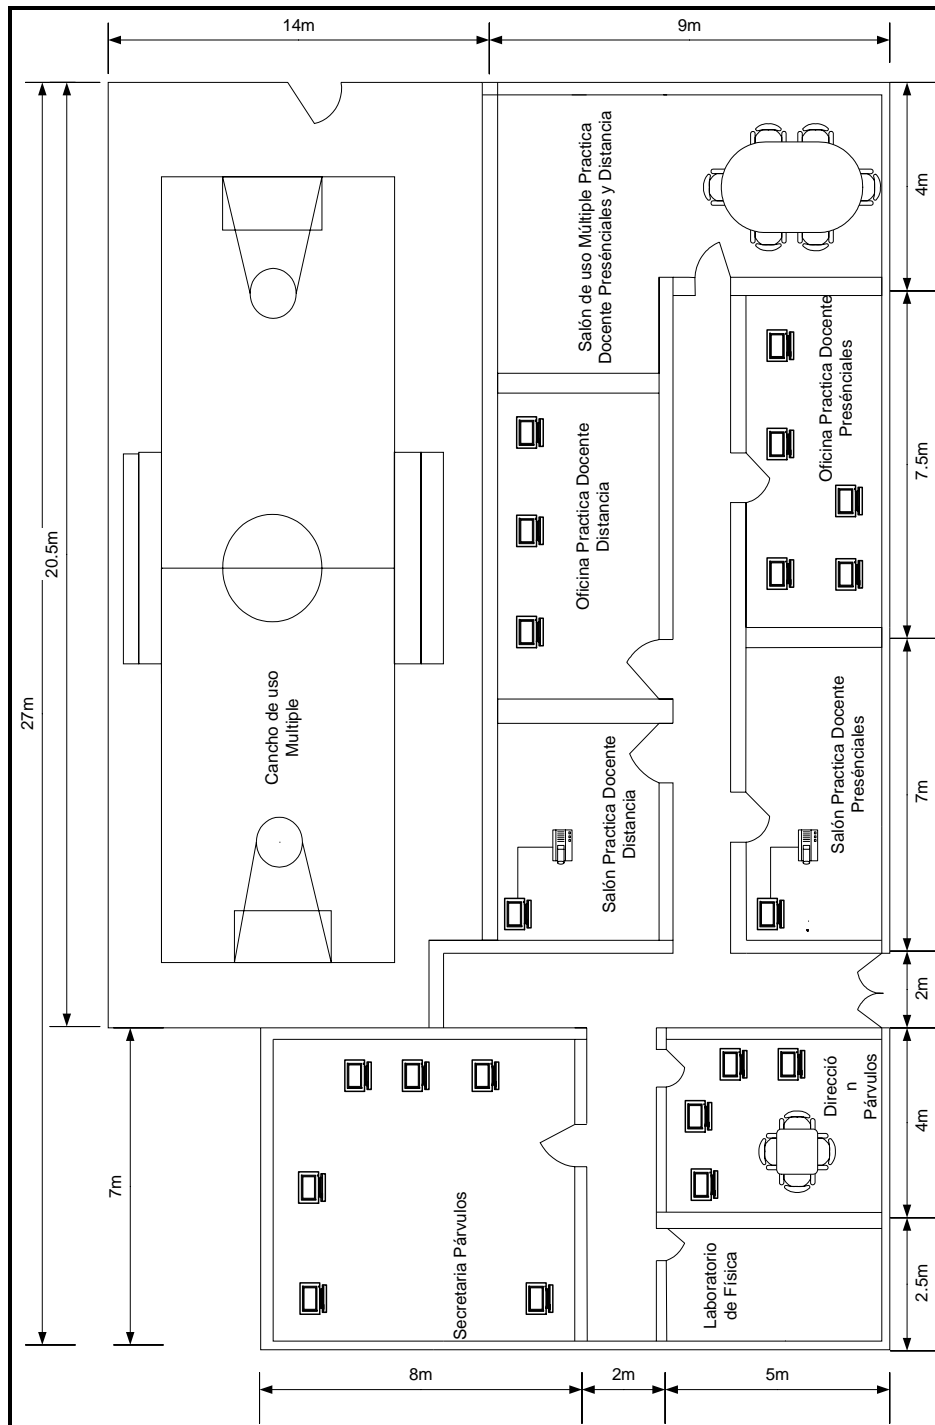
Plano Digital Planta Baja - Edificio de Párvulos
